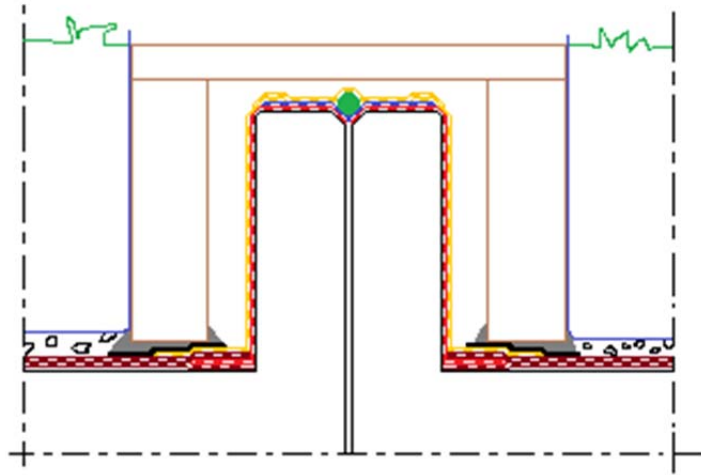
Cas du joint visible sous dalle - Terrasse jardin
